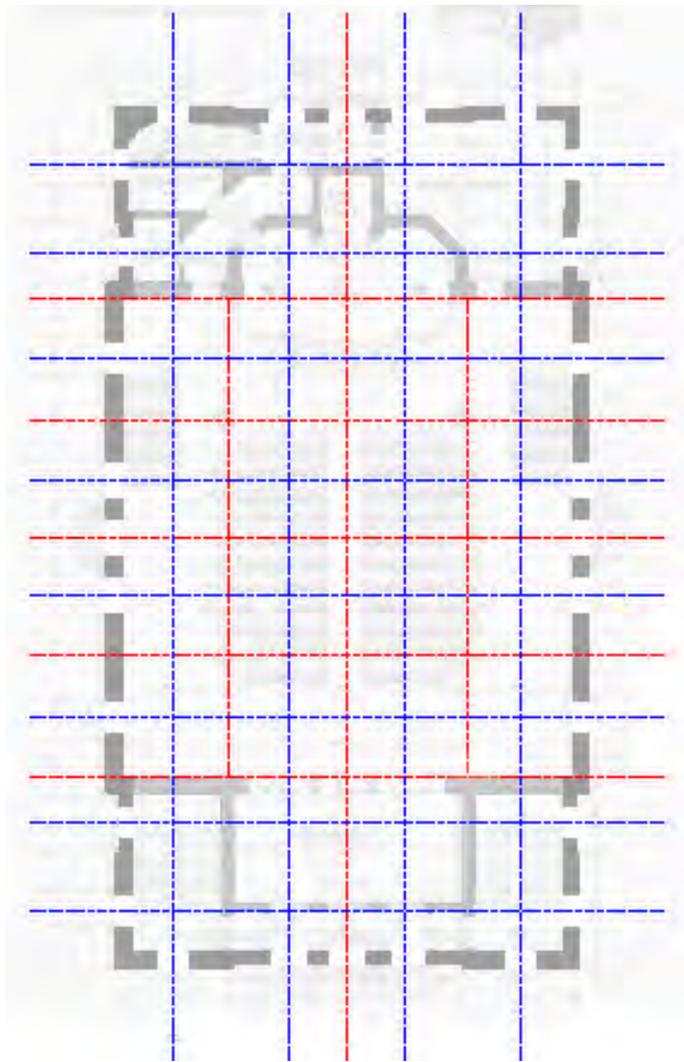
das angelegte Rastersystem im Grundriss
